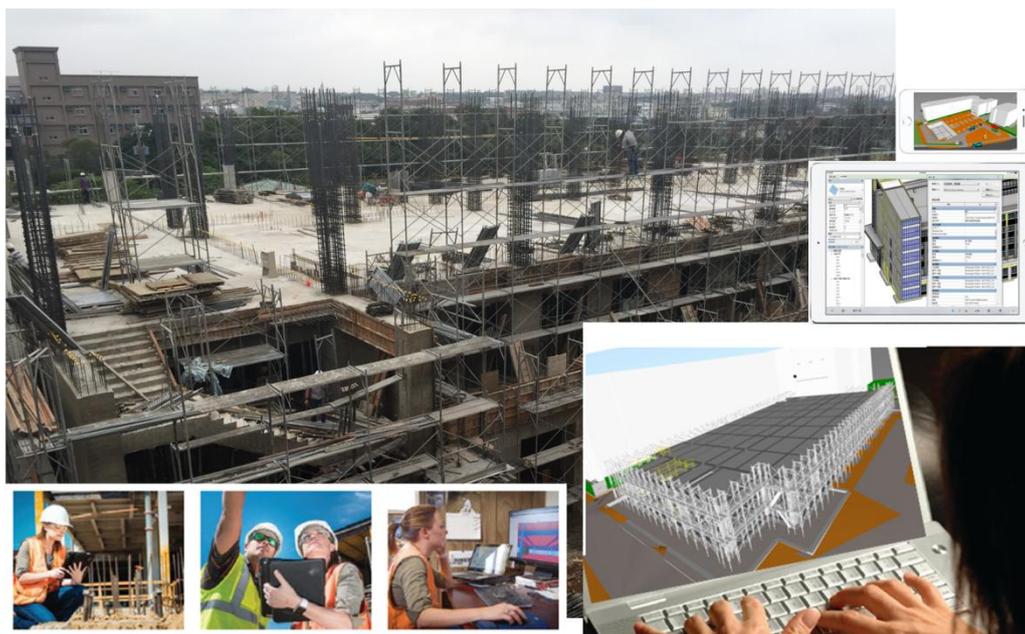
施工方應用 BIM 做施工管理決策概念圖
